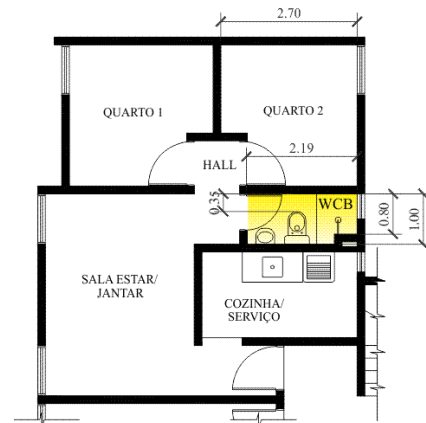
Planta Baixa Pav. Tipo: Setor Íntimo do Residencial Costa Dourada (sem escala)
